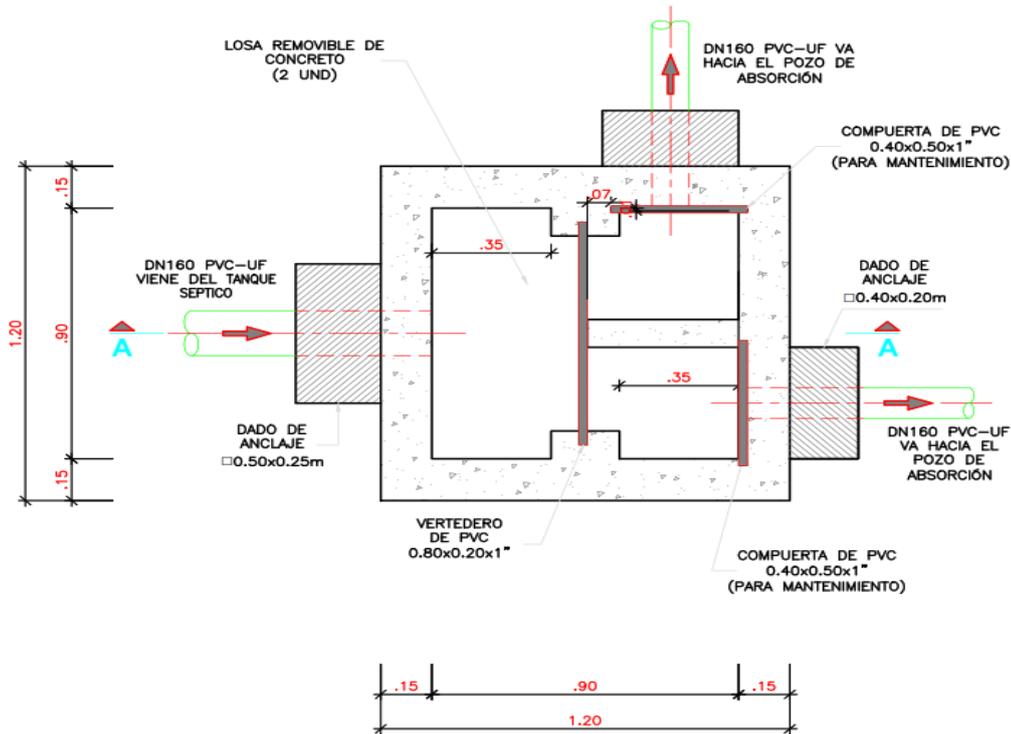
Planta cámara Distribución de Caudales – PTAR La Tranca
